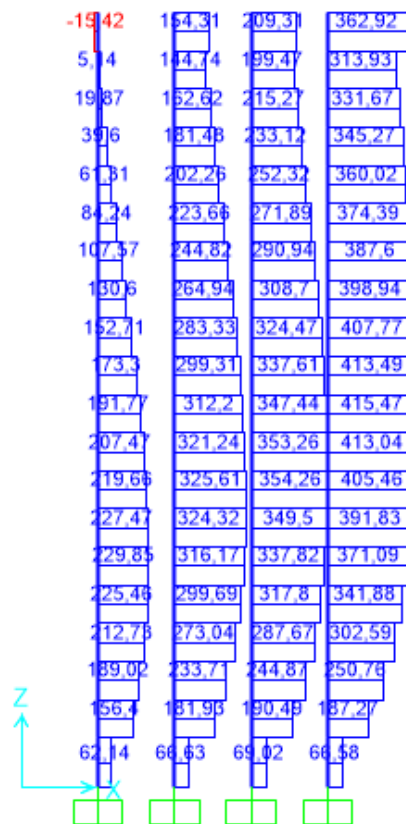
Esfuerzos cortantes en columnas, pórtico C
